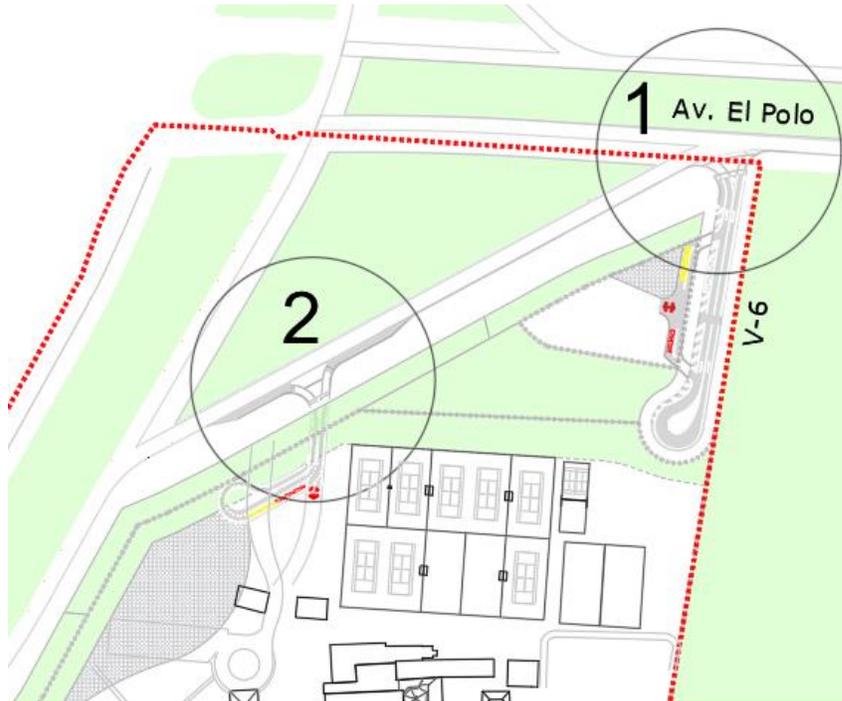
Detalle Propuesta Accesos a Plan Parcial No. 06
